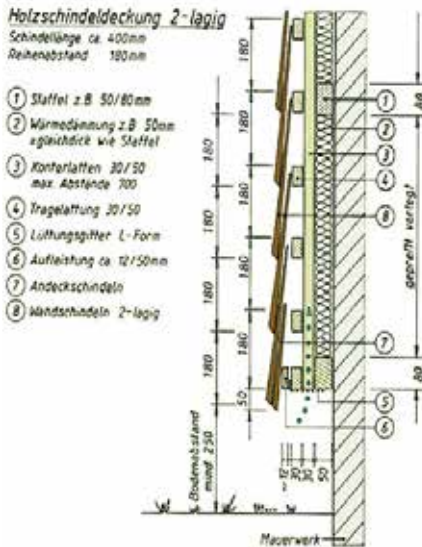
Lattenrostaufbau am Mauerwerk mit eingebauter Wärmedämmung
